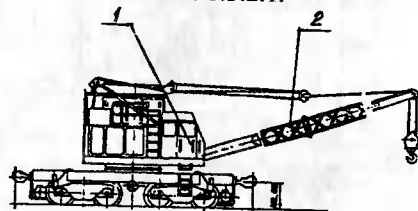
Кран строительно-монтажный КЖС-16:
